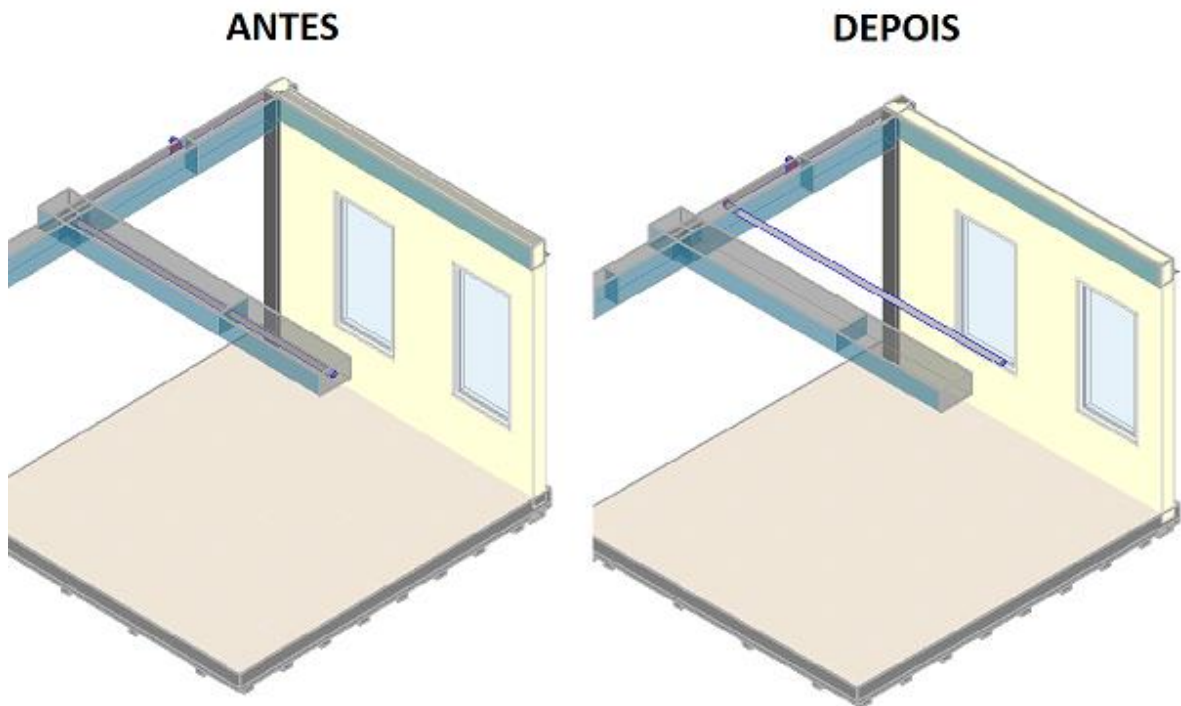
Conflito tubulação com viga (Pavimento 1)
